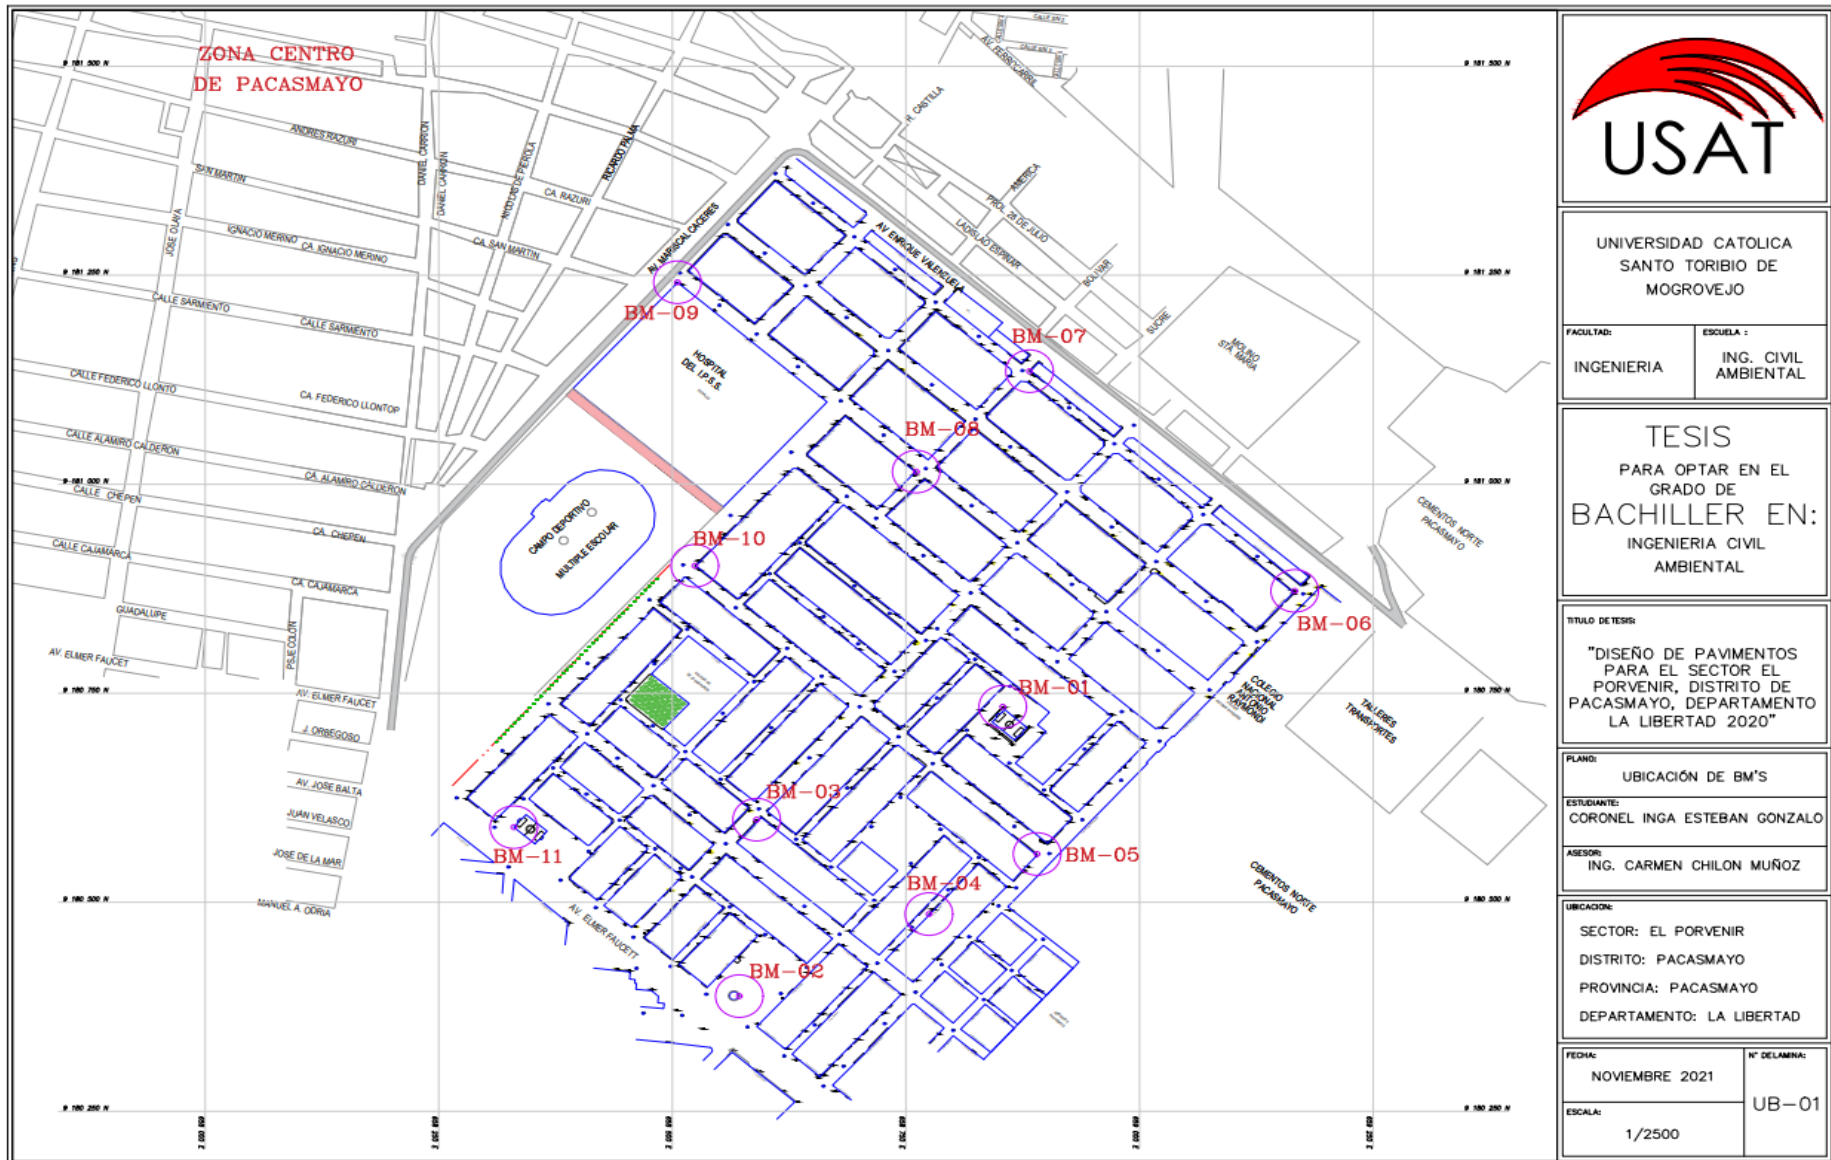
PLANO DE UBICACIÓN DE BM- FUENTE: ELABORACIÓN PROPIA
